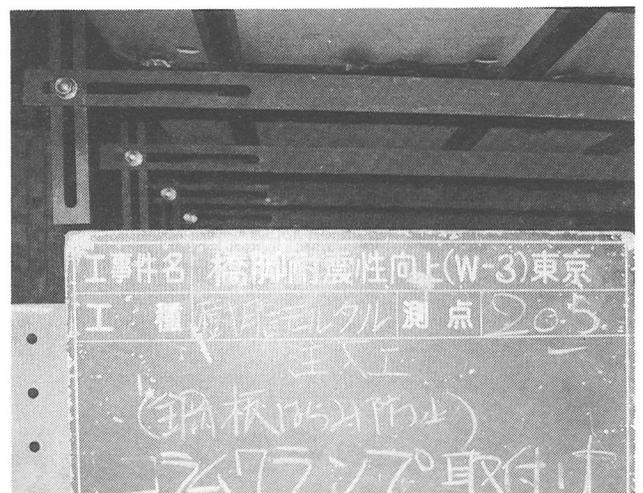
鋼板巻立て樹脂モルタル注入工法施工写真
